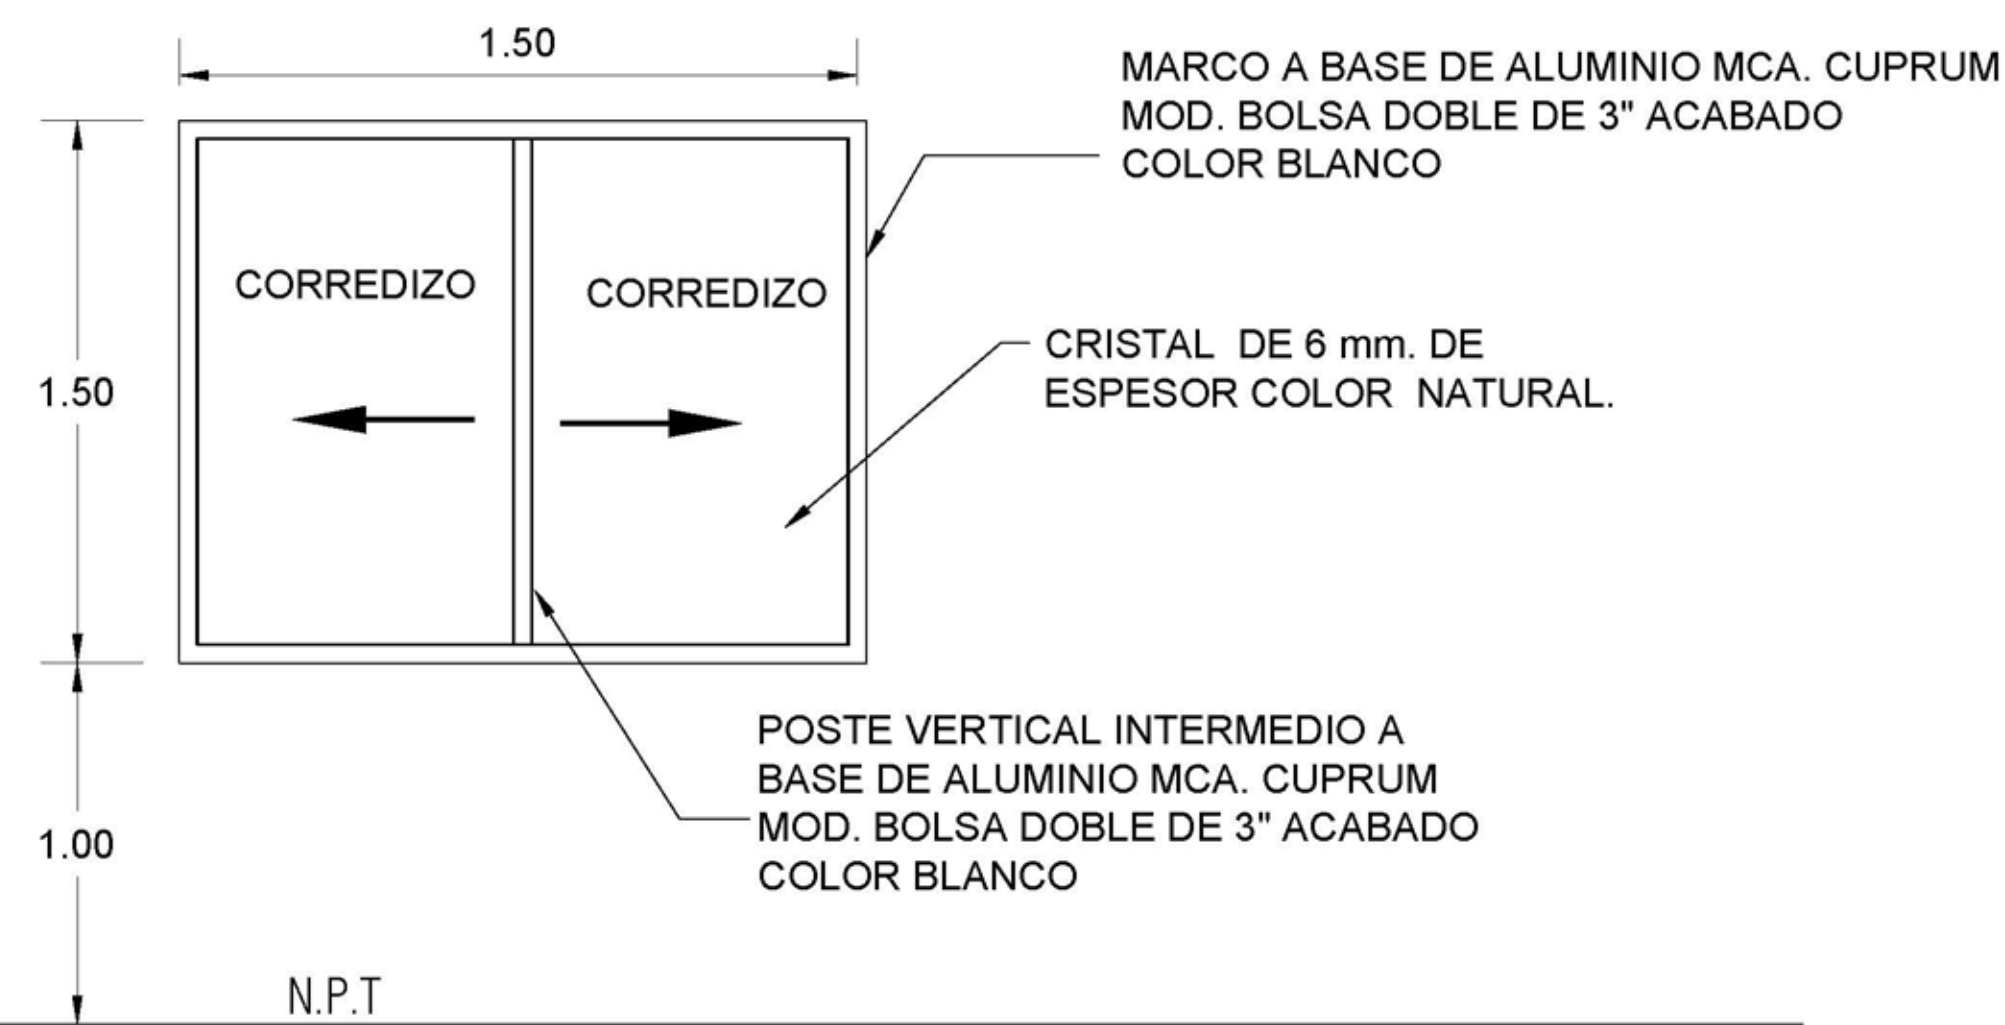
FACHADA: ACAB      CONSECUTIVO: 06
